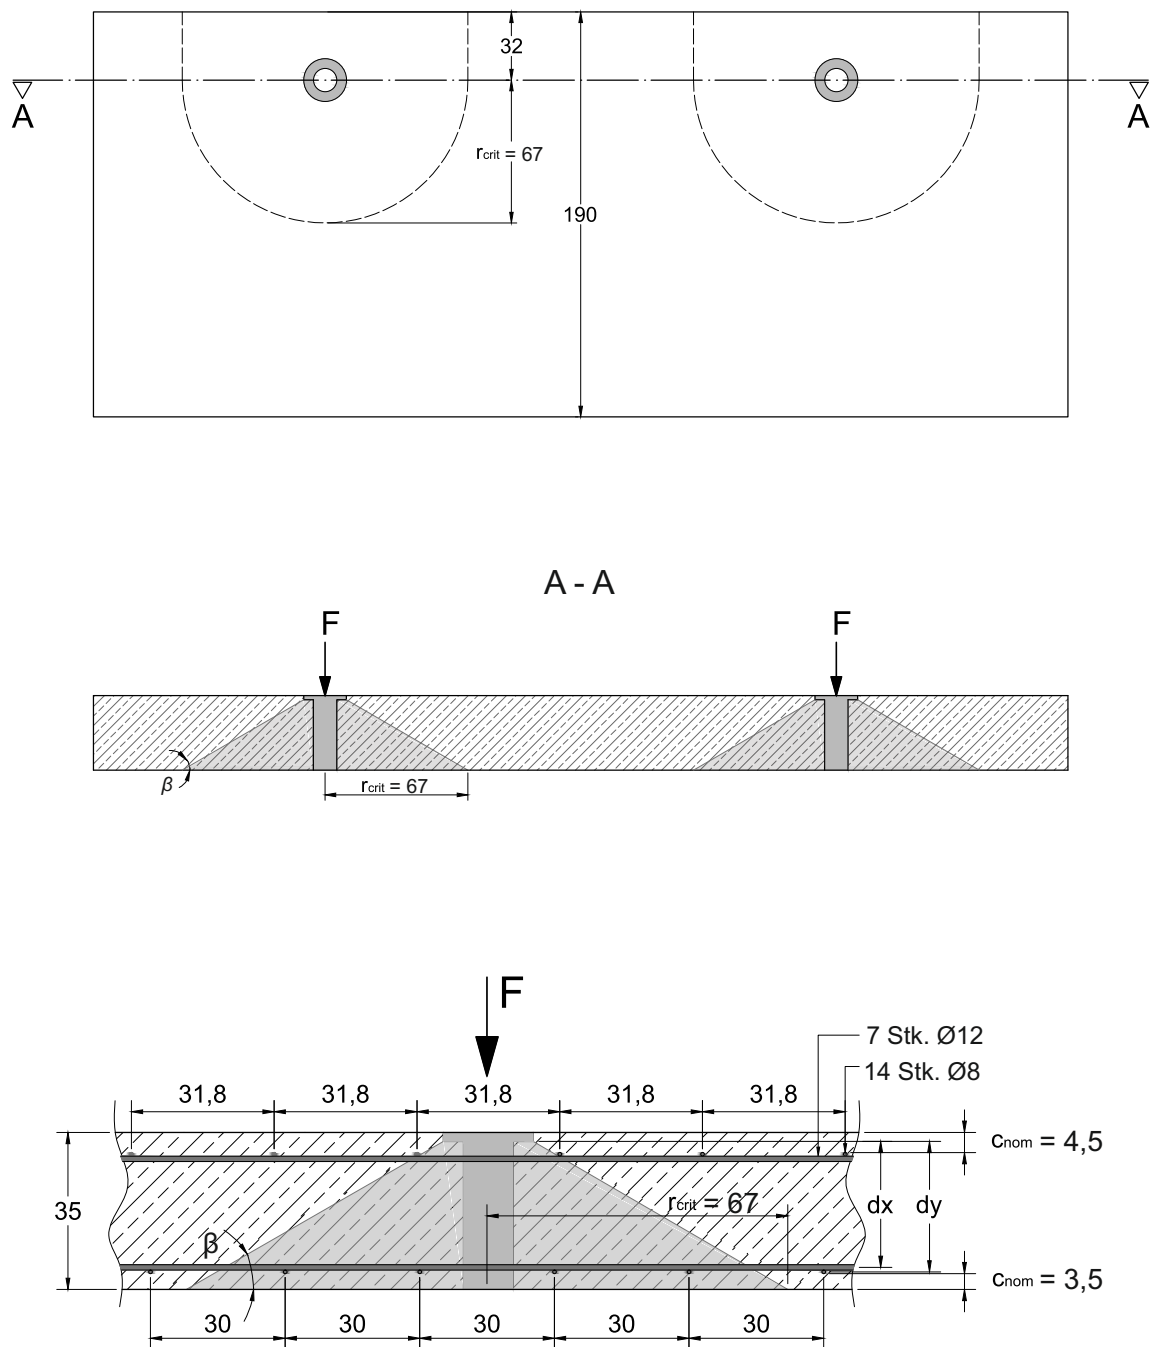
Geometrie des Durchstanzbereiches bei punktförmiger Belastung eines Tübbingsegmentes; oben: Abmessungen des kritischen Rundschnittes um den Lasteinleitungsbereich; Mitte: Darstellung der Lastausbreitung im Tübbingquerschnitt; unten: Bewehrungsführung im Durchstanzbereich
